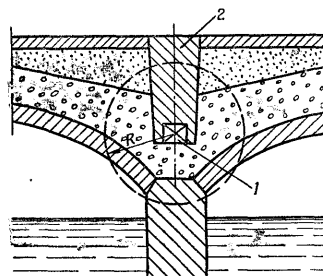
Подрывание опоры каменного (бетонного) моста сосредоточенными зарядами в колодцах:
